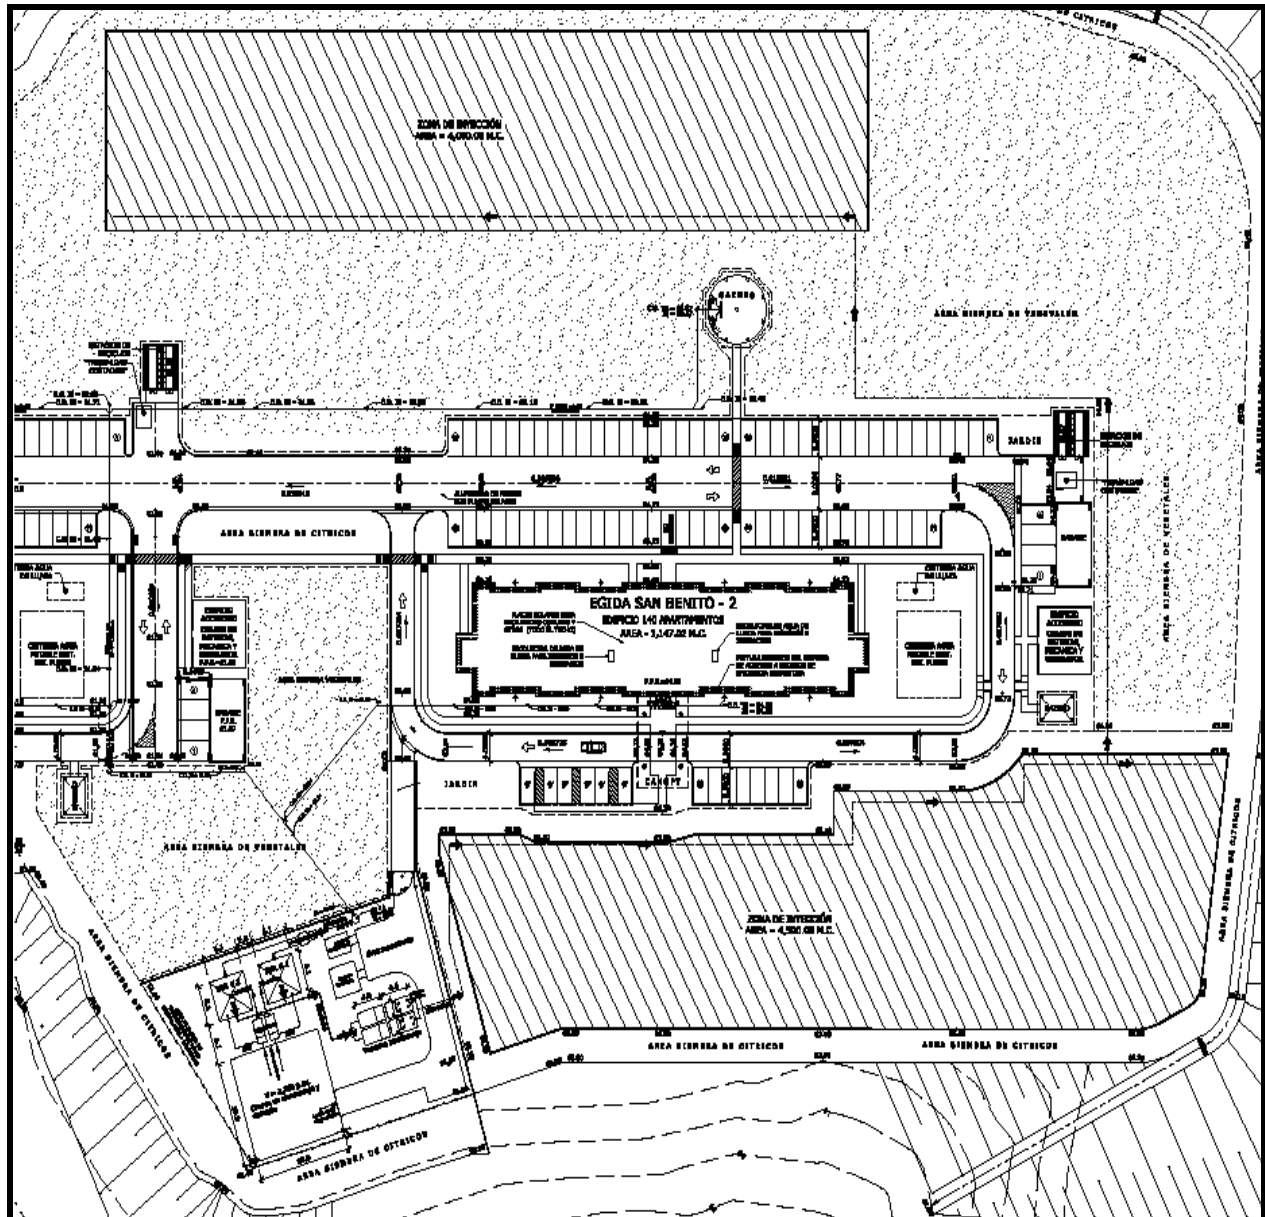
Plano conceptual de área del sistema de inyección subterránea
